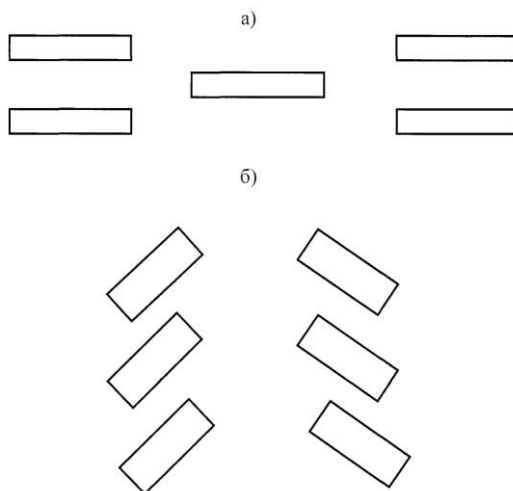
Схемы размещения зданий и сооружений на территориях
